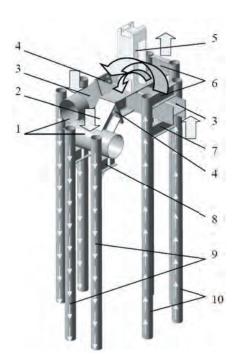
Фрагмент конструкции металлического свайного фундамента: 1 – упор; 2 – главная балка; 3 – второстепенная балка; 4 – фланцевое соединение; 5 – опора барьера; 6 – верхняя объединяющая балка; 7 – нижняя объединяющая балка; 8 – опорный столик; 9 – сваи «несвязанные»; 10 – сваи «связанные»
